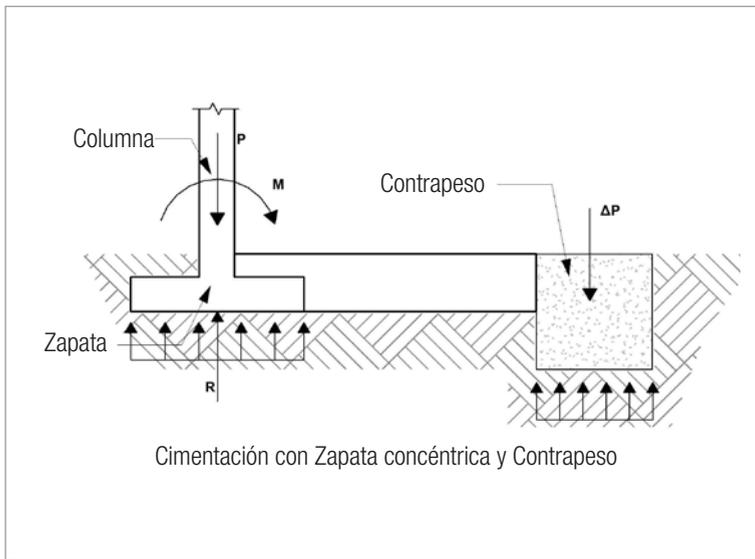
Cimentación con zapata concéntrica y contrapeso.
